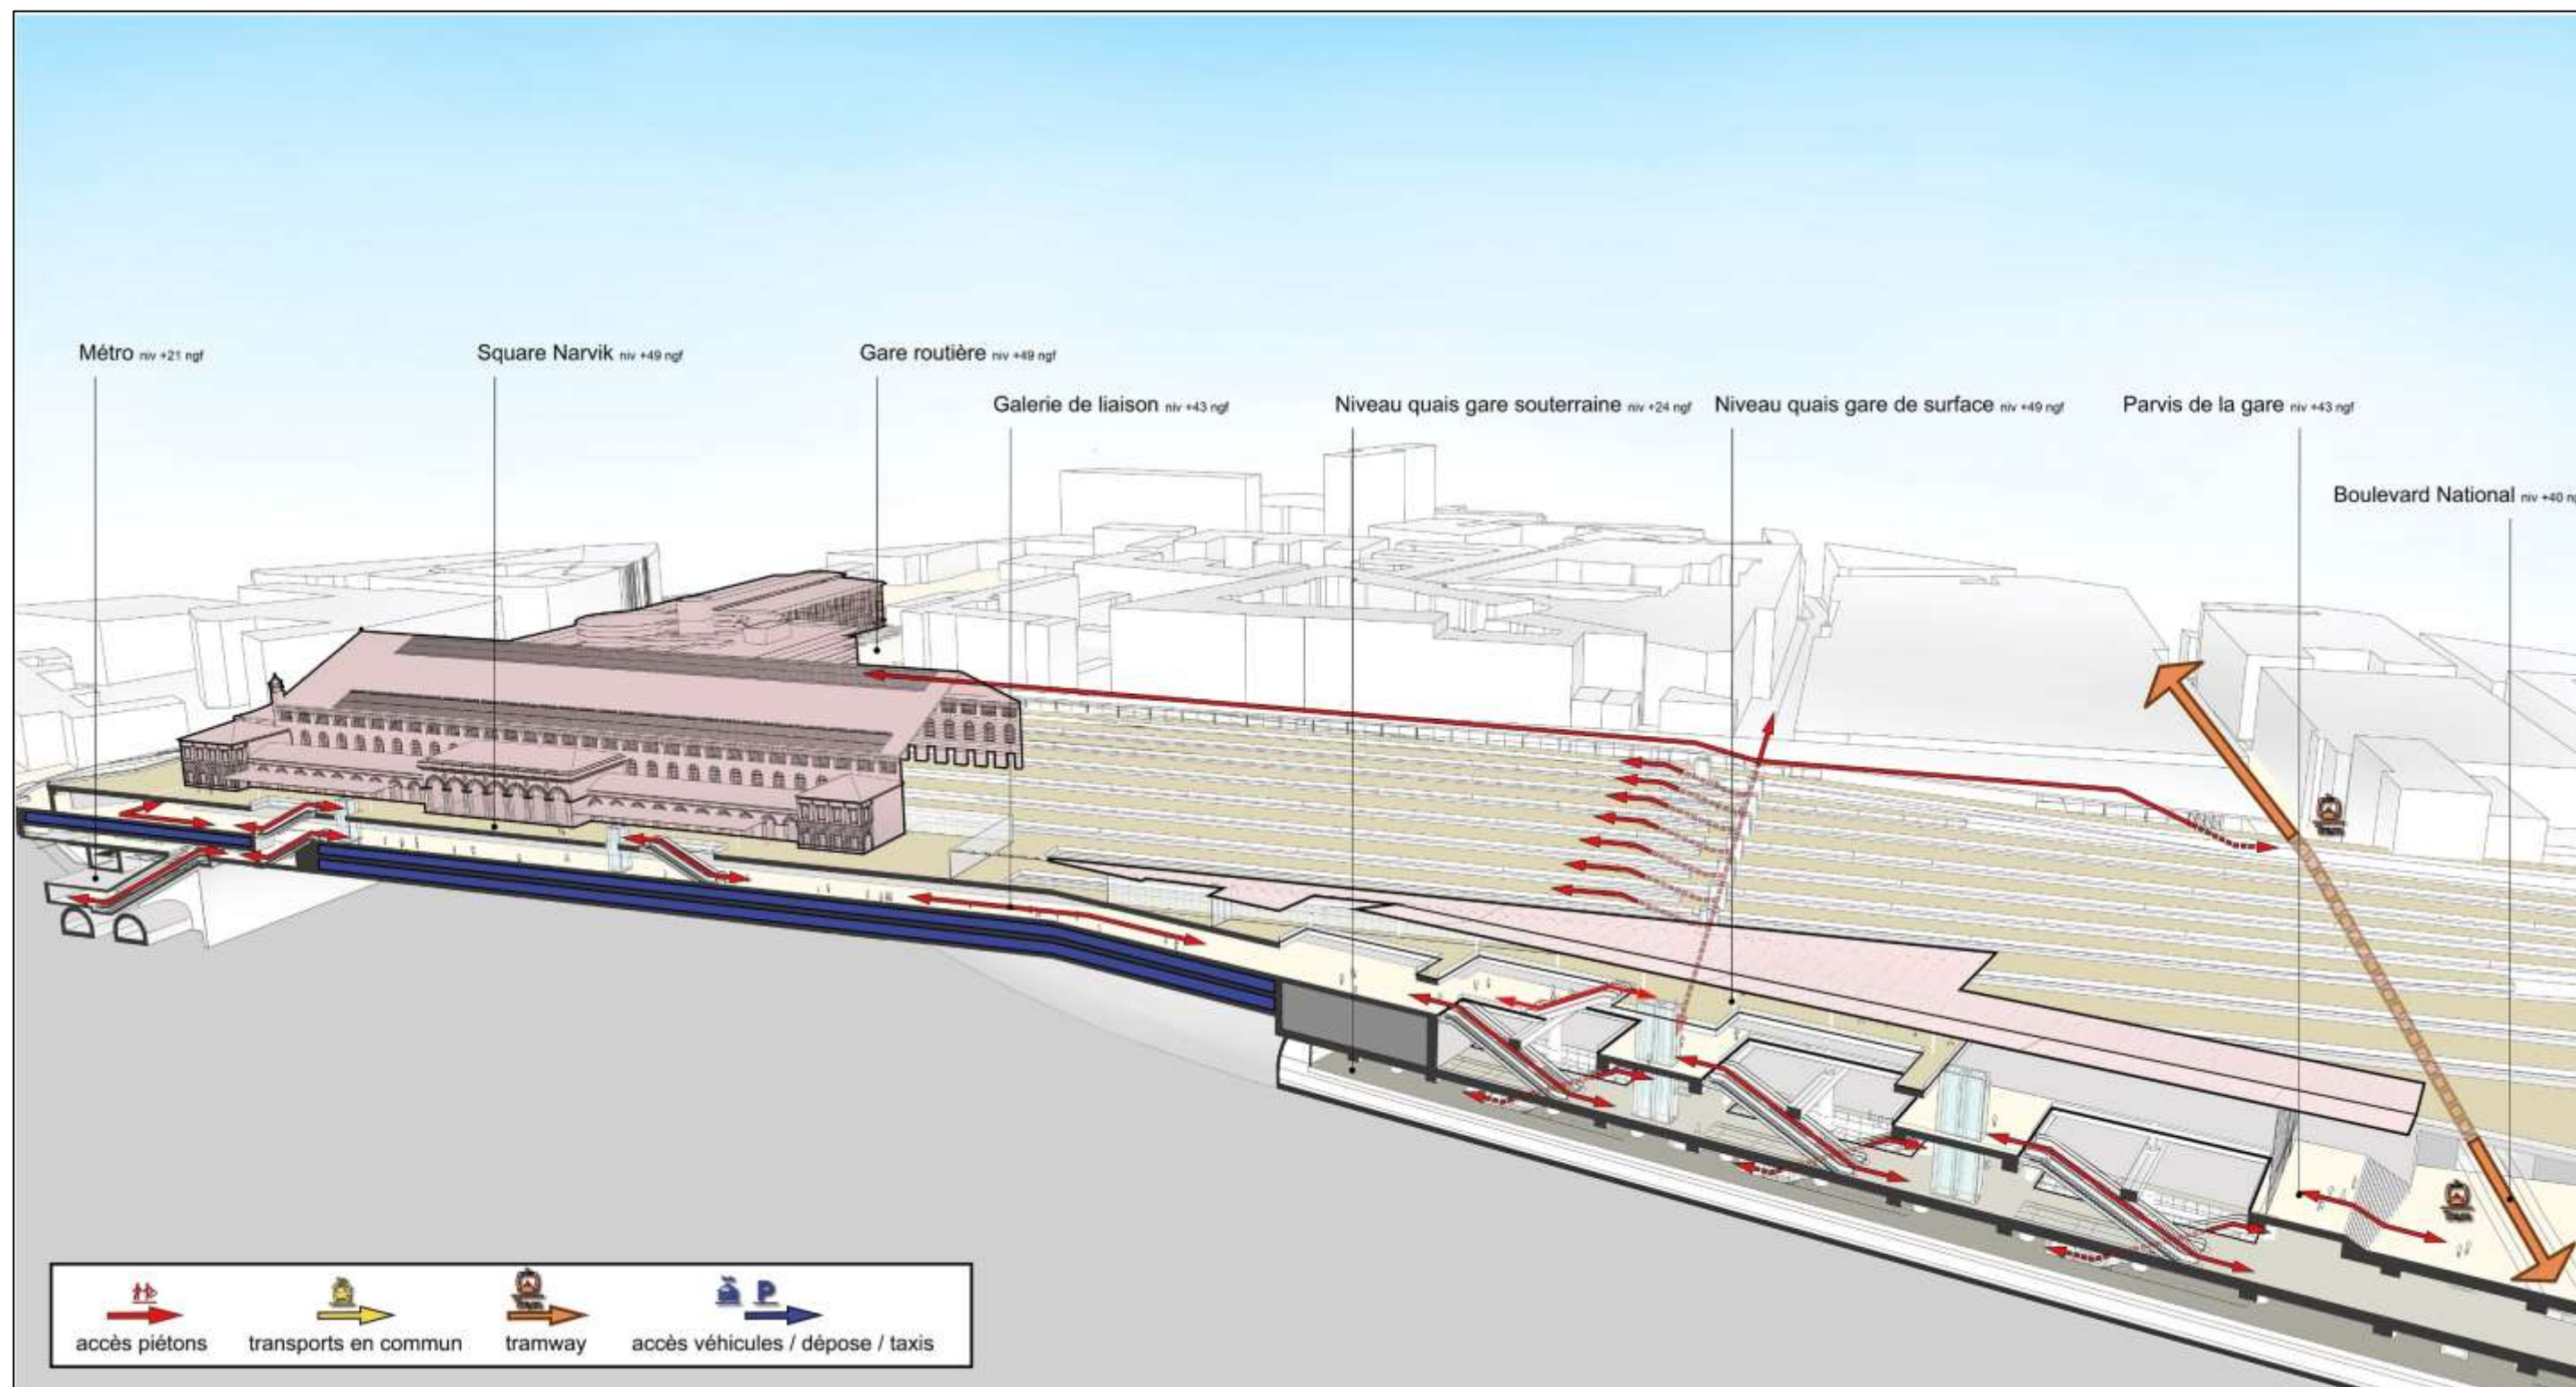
Coupe longitudinale sur le site de St-Charles - principe des échanges internes gare
